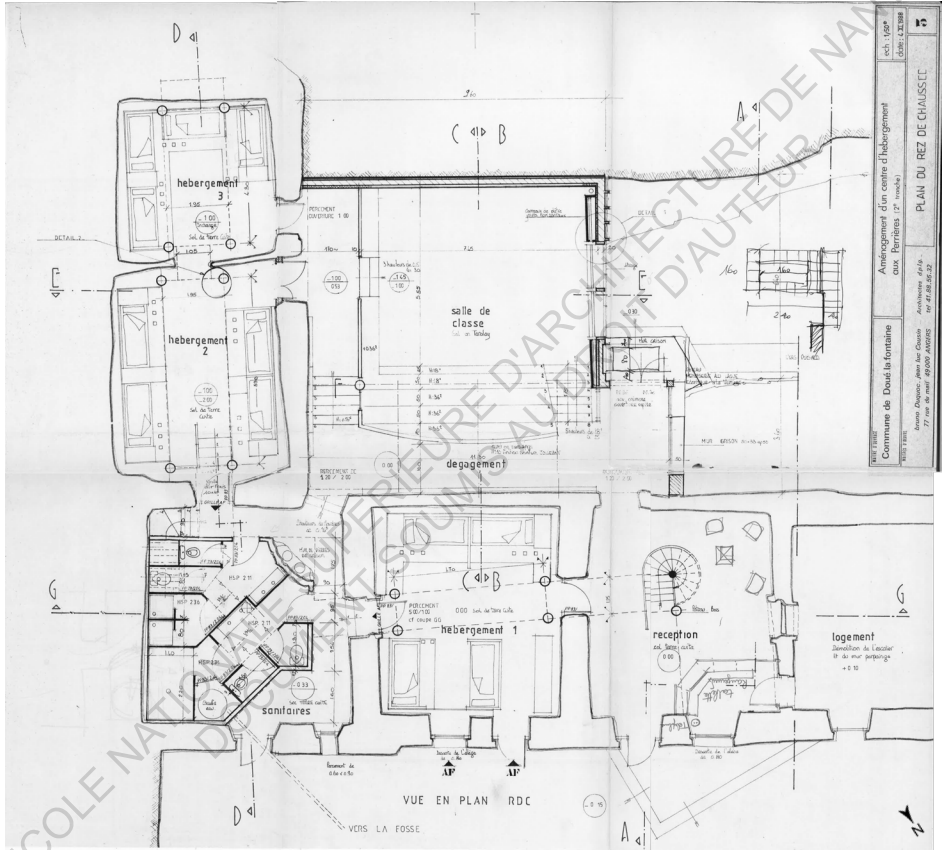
, Bruno Duquoc et Jean-Luc Cousin, Plan du rez-de-chaussée du centre d'hébergement des Perrières, Doué-la-Fontaine, 1988.
